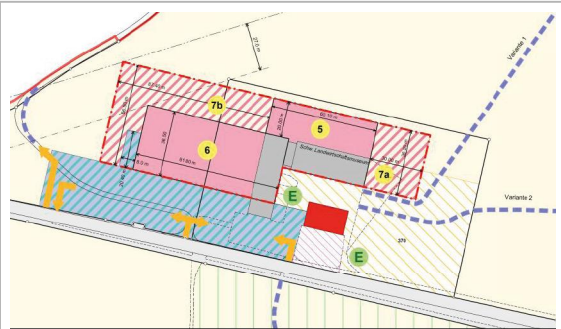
Bebauungsplan neu, div. Anpassungen.
